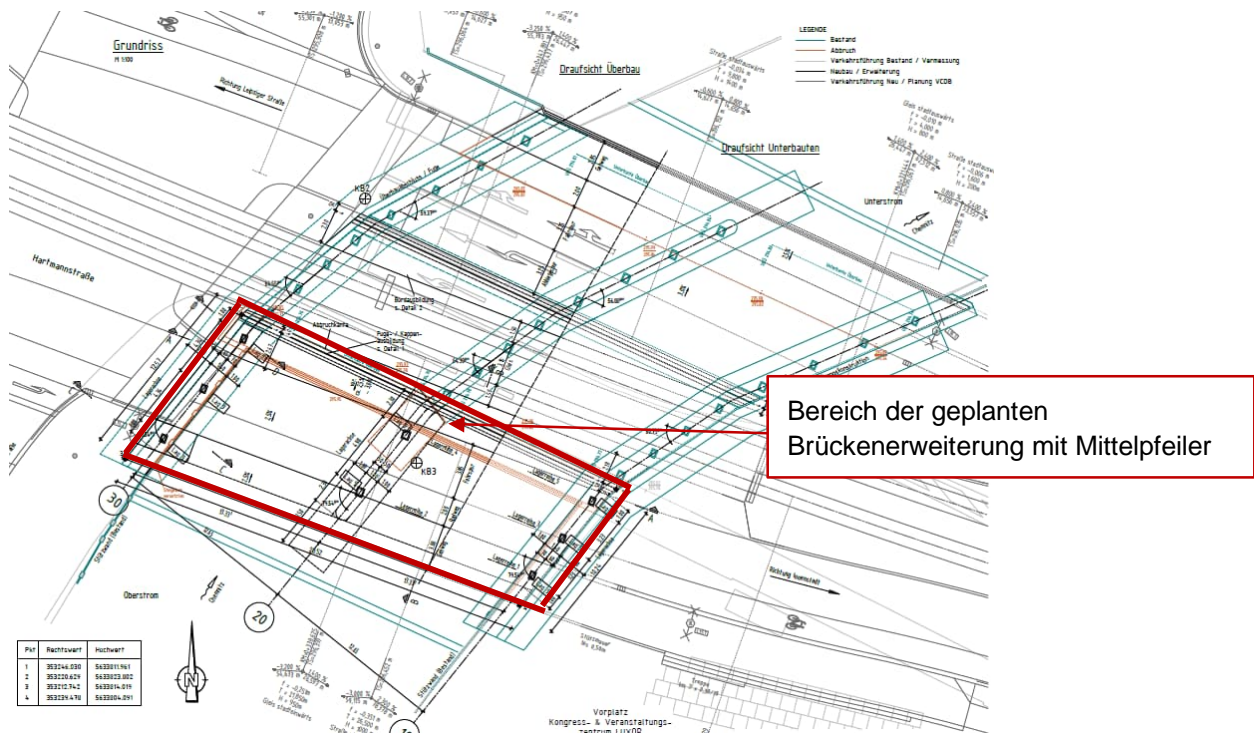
Erweiterung Brücke Hartmannstraße - Brückengrundriss (Entwurfsplanung BPR - Arbeitsstand 08.12.2023)⁷
